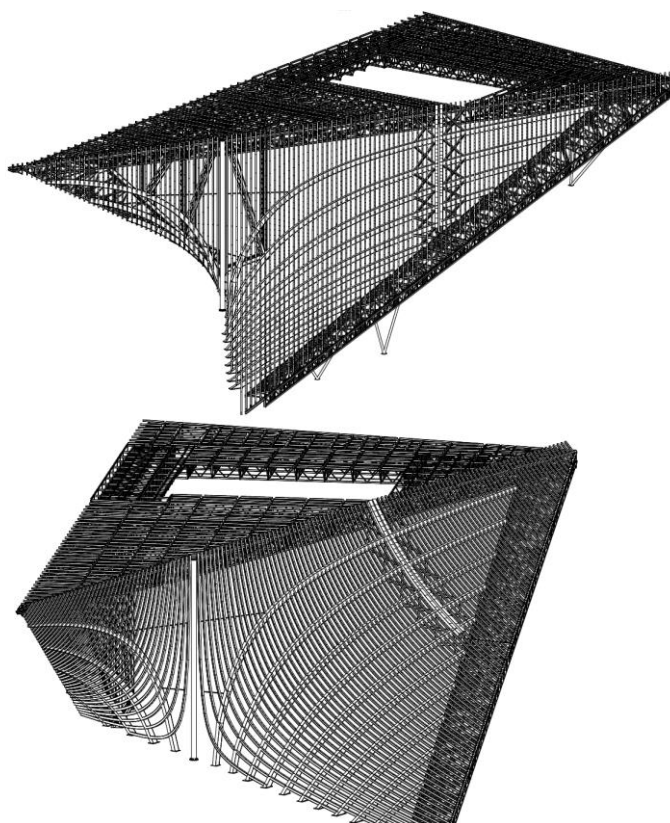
Общий вид стальных конструкций Театра оперы и балета
